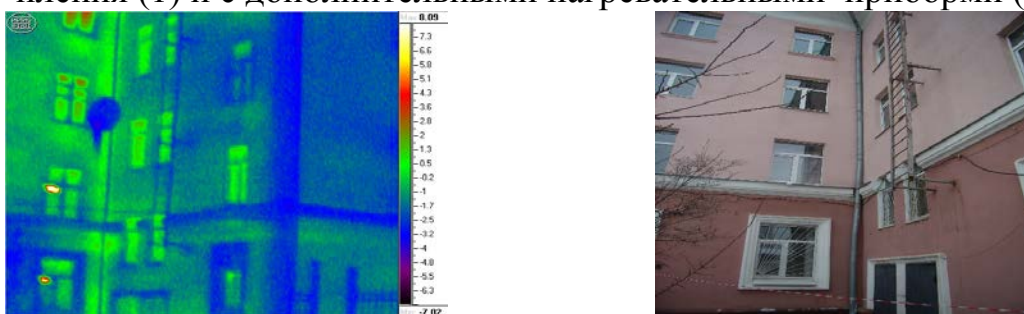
Дефект конструкции здания. Стык между фасадами С и Д.
